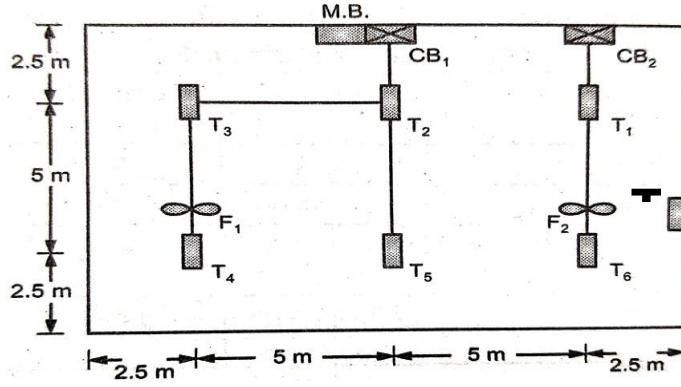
क्लासरूम प्लॅन (Classroom Plan)
